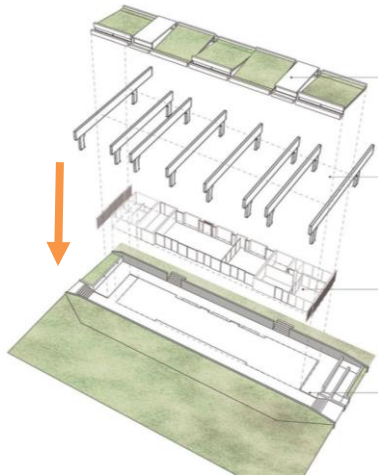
Ficha de análisis arquitectónicos N°4
